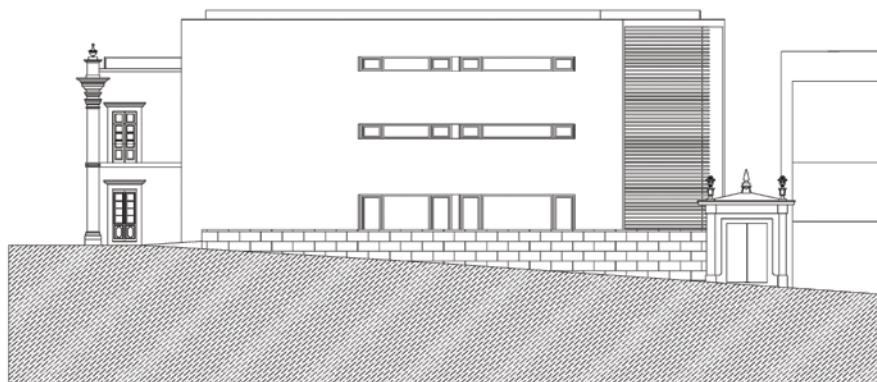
Planta da fachada principal antes das obras de remodelação. Fonte: Divisão de Gestão, Planeamento e Desenvolvimento Urbanístico – Câmara Municipal de Penafiel.
